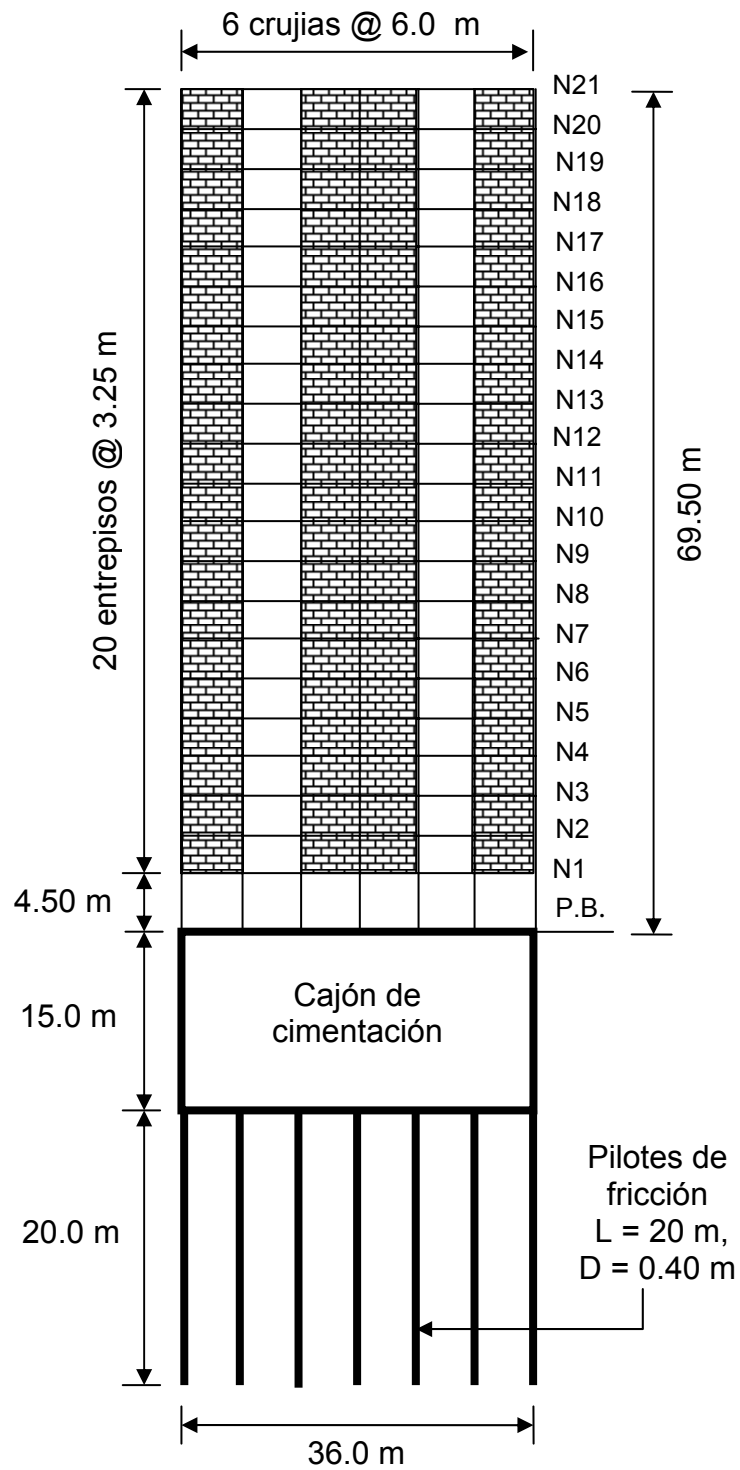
Vista en elevación (corte b-b) de la estructura de 21 niveles
